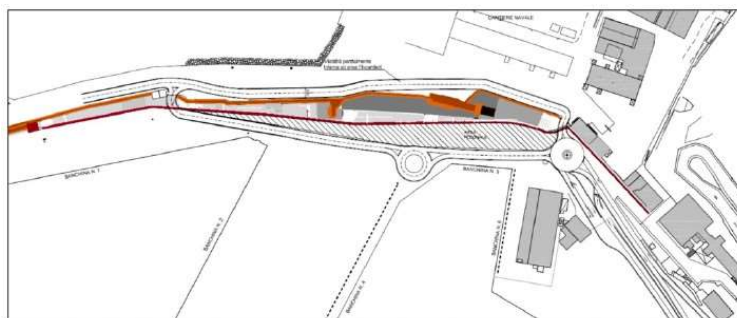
Viabilità con sede in area portuale ed eventuale strada in area Fincantieri – Ipotesi A (stralcio Tav. 8)
